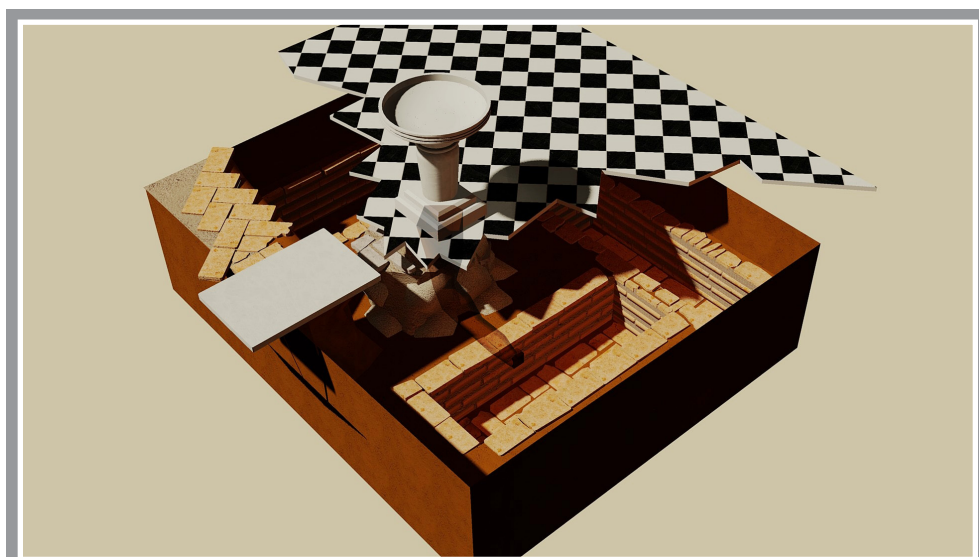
Propuesta de reconstrucción del sistema de evacuación de la pila bautismal.
